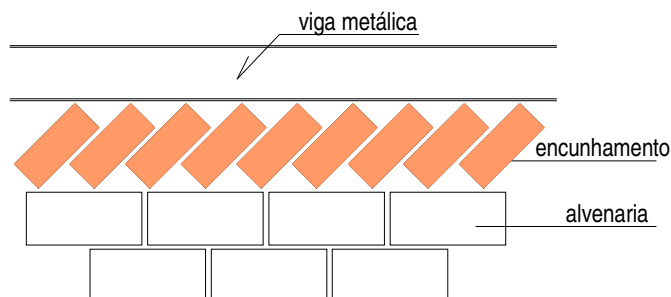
Sistema rígido: encunhamento entre alvenaria e estrutura
